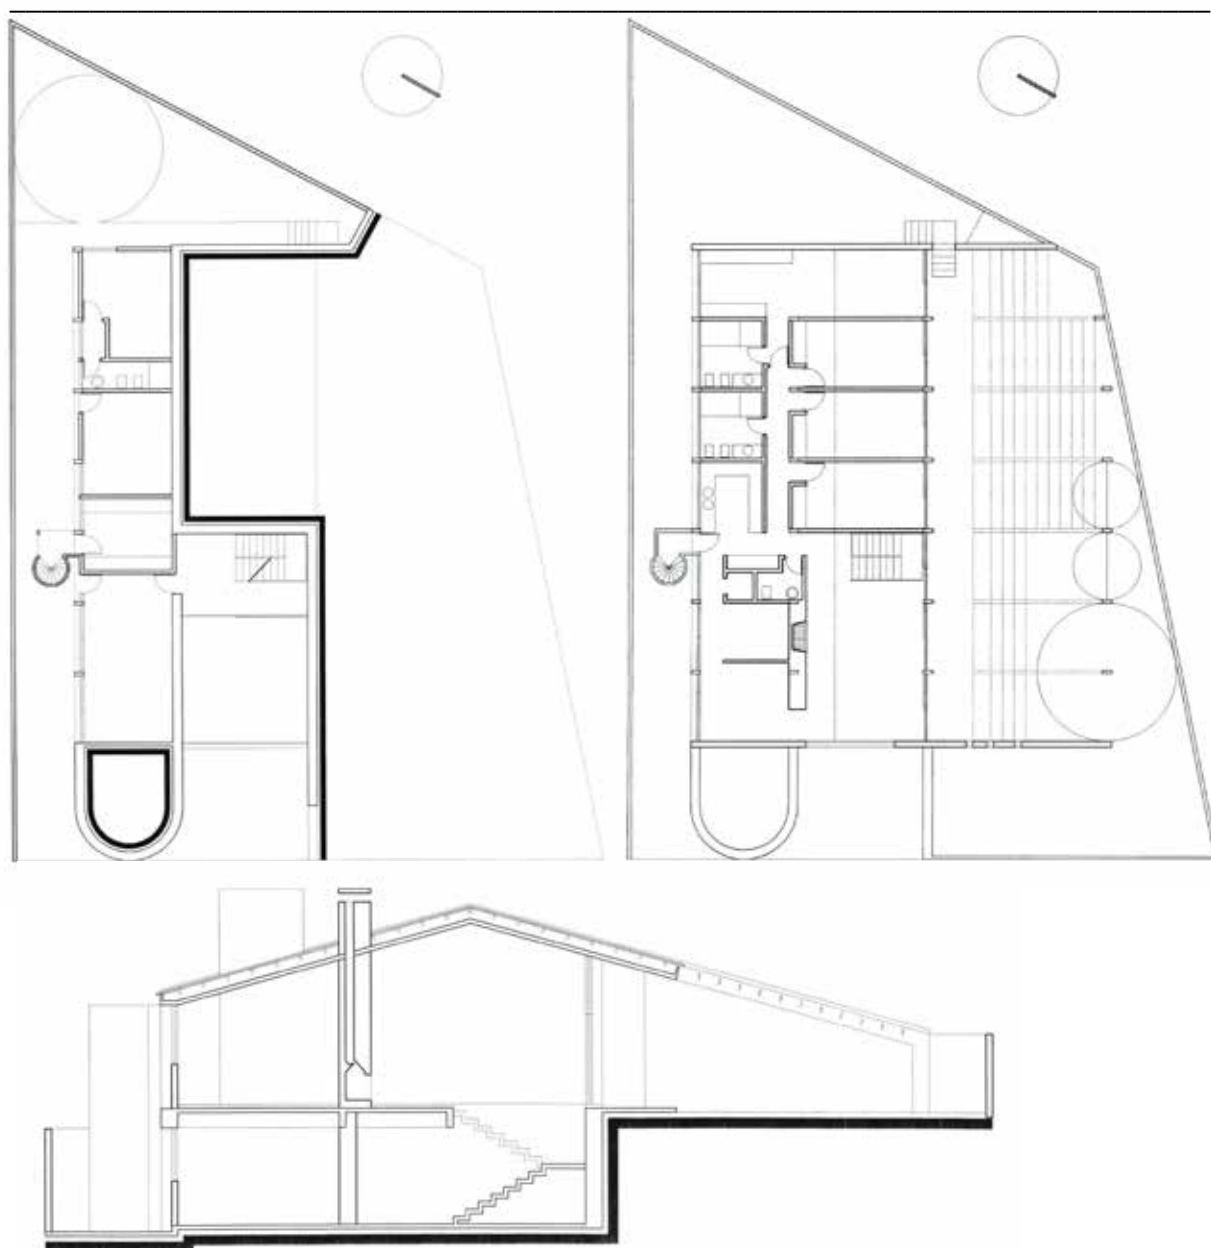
planta de subsolo: voltado para a rua têm-se a garagem e um escritório. As demais peças são de serviço.
